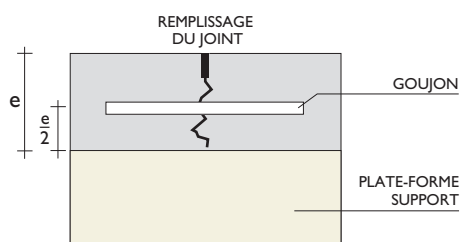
Schéma d'un joint de construction (transversal ou longitudinal)
